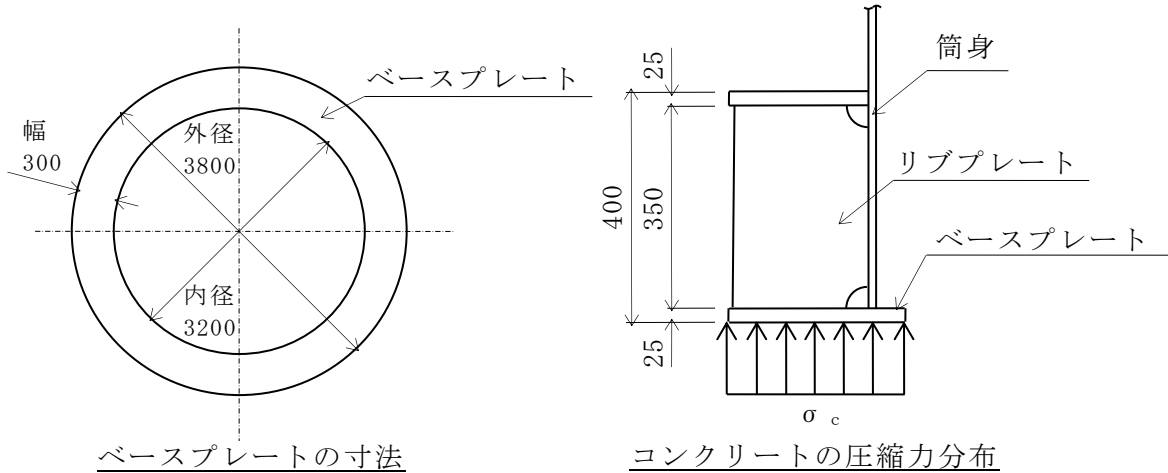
ベースプレートの概要図及びコンクリートの圧縮力分布図 (単位: mm)
